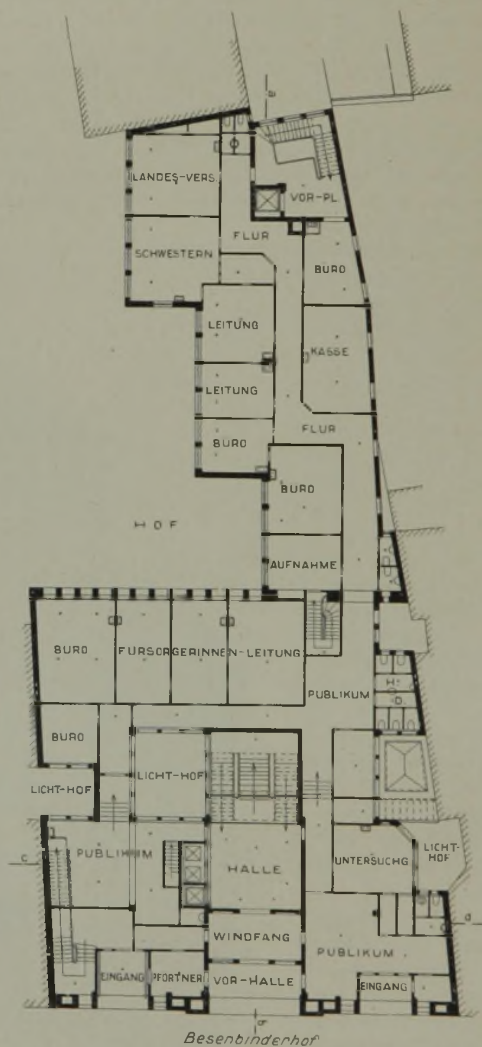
Grundriß des Erdgeschosses. (1:500.)
